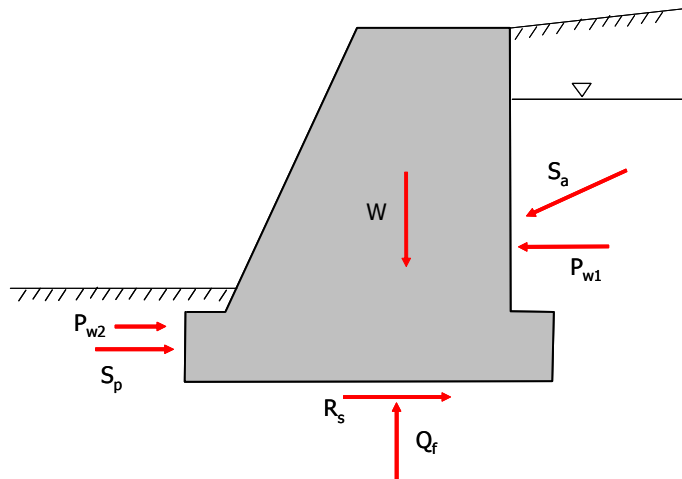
Rappresentazione schematica delle forze agenti su di una struttura a gravità -
